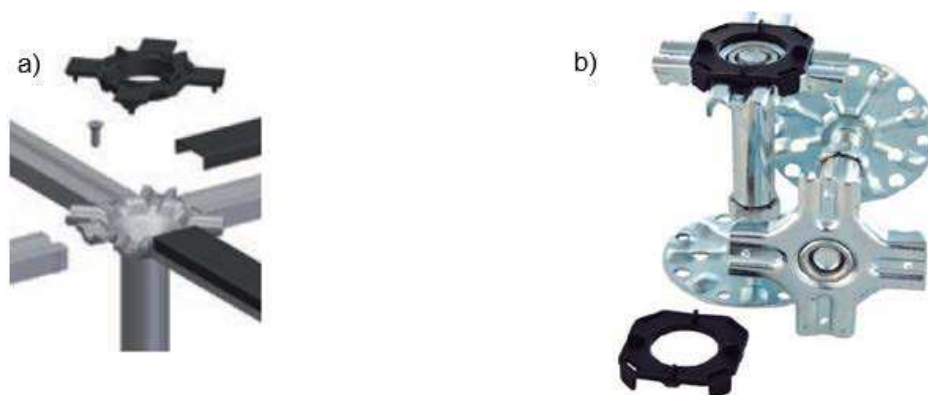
a) Pedestal com traves de ligação [63]; b) Pedestais e juntas plásticas [63]
